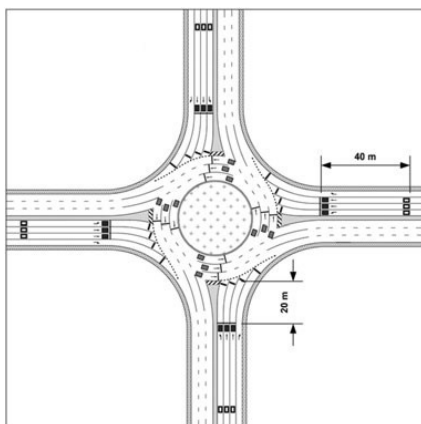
Plan faza u slučaju favorizovanja levih skretanja
